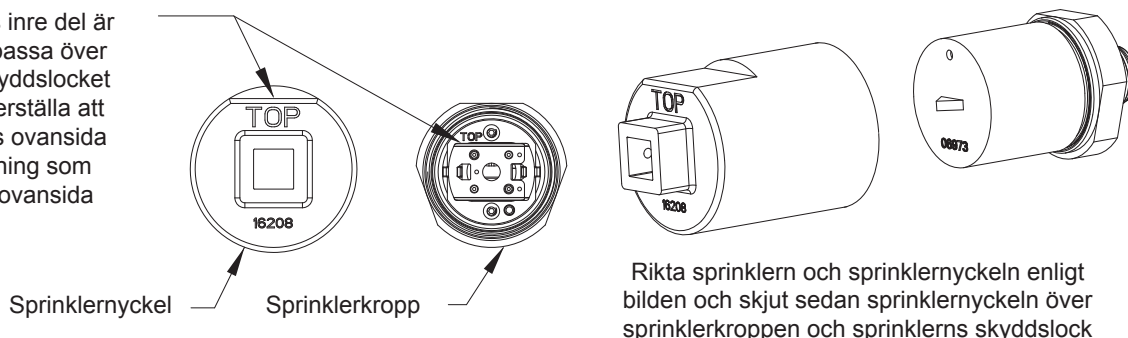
Installation av sprinkler VK480 och korrekt användning av sprinklernyckel
